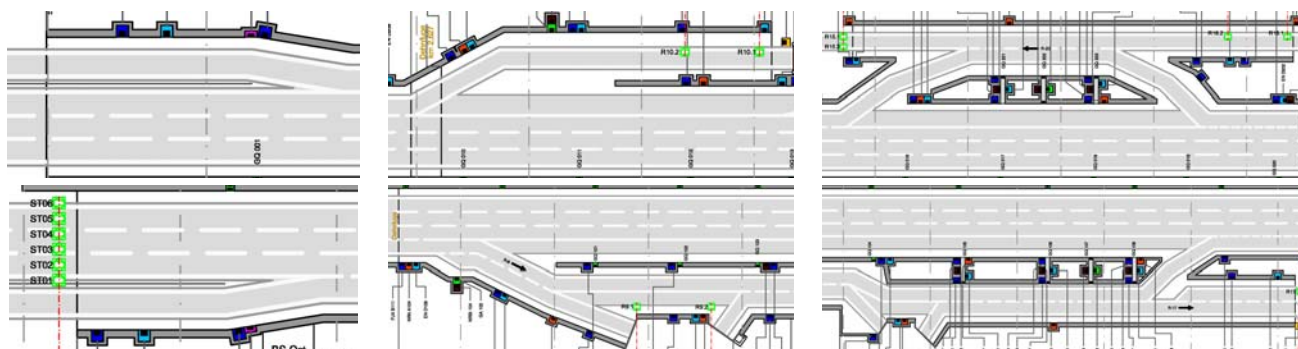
esquisse de l'installation de ventilation des tunnels des bretelles
